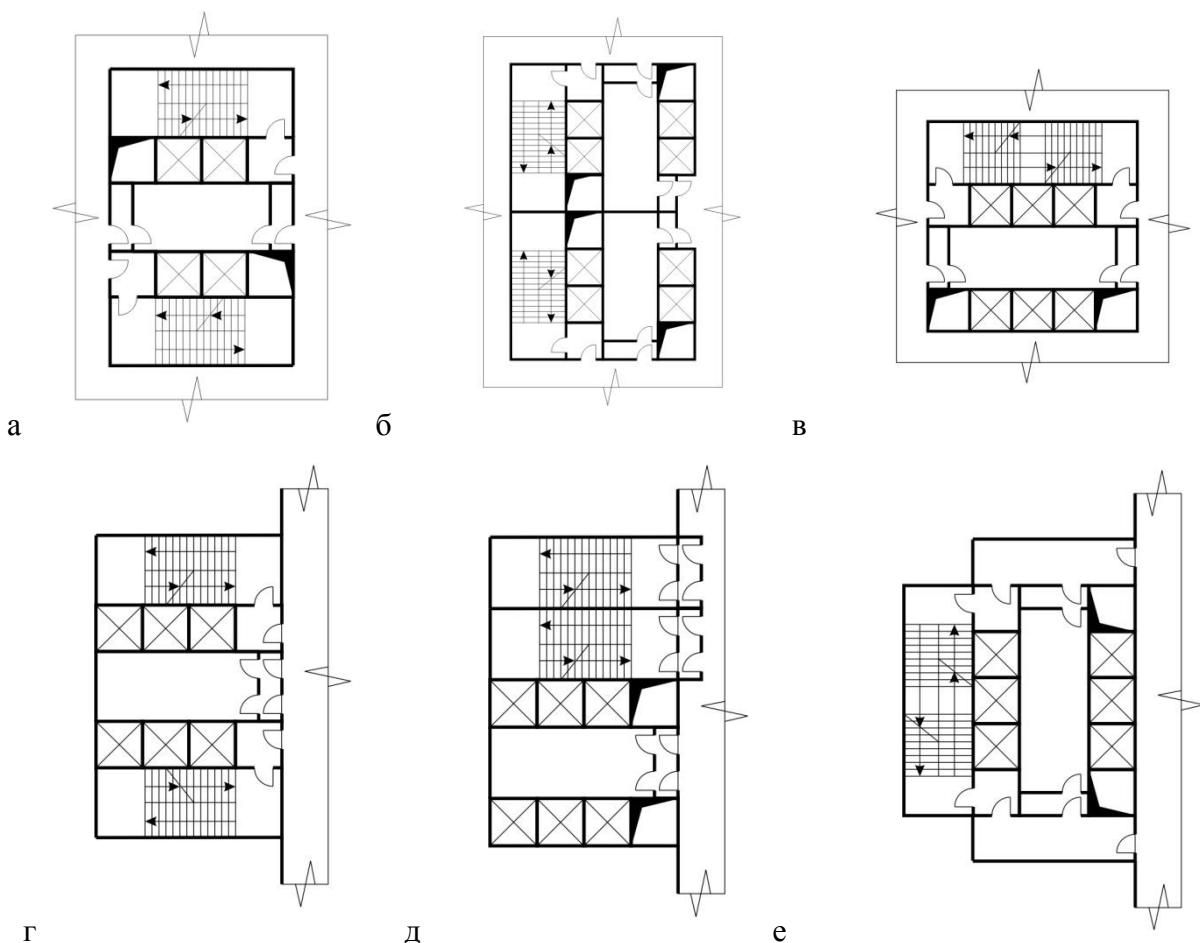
Архитектурно-планировочное решения лестнично-лифтовых узлов высотных зданий:
